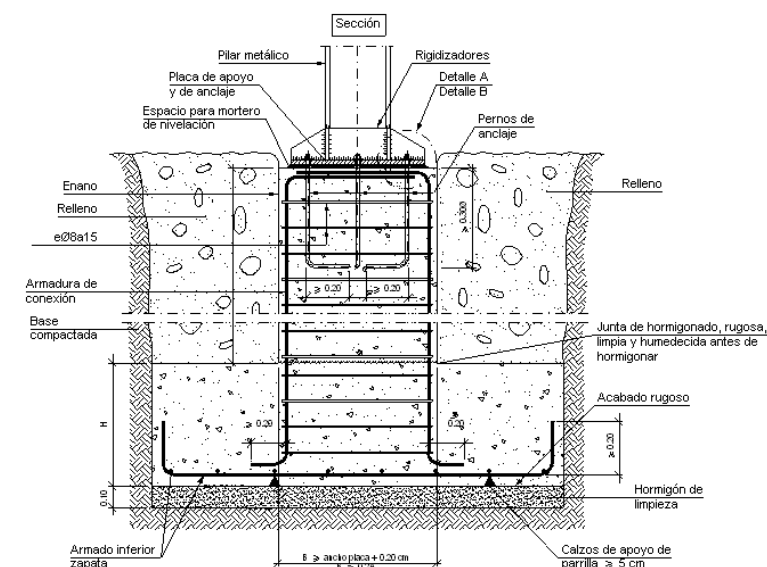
Detall constructiu de la sabata de formigó dels pilars metàl·lics i la unió d'aquesta amb la base del pilar, de l'espai destinat a les cambres higièniques.
